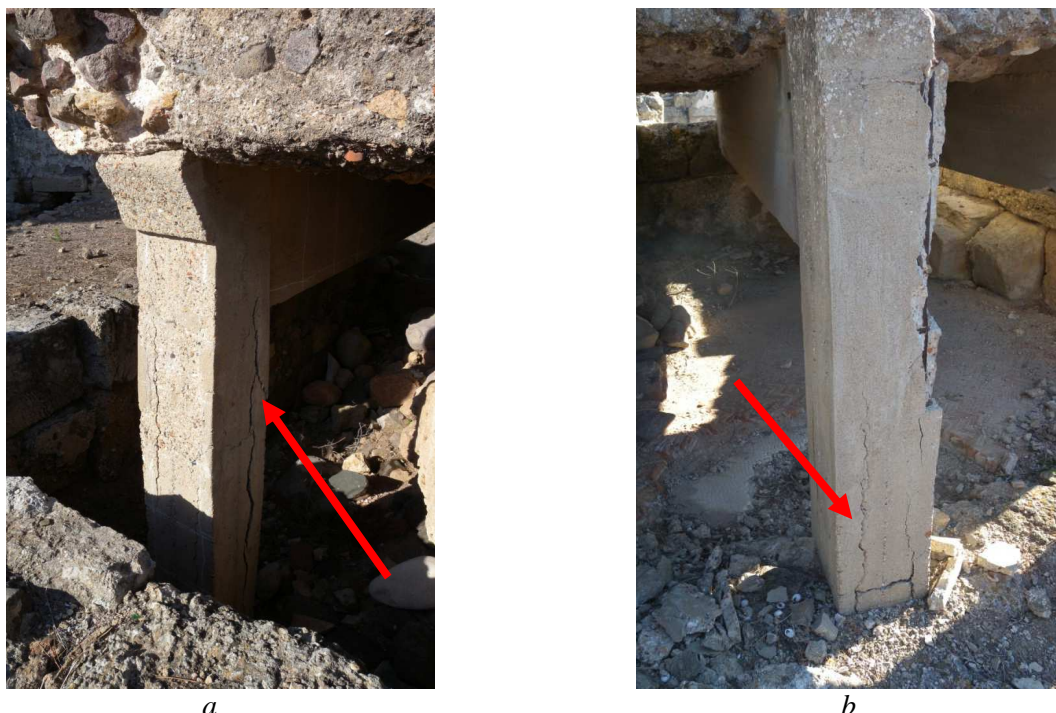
Vista sud del pilastro D; b: Vista ovest del pilastro B della zona 1–terme centrali. In rosso sono indicate le fessure.
